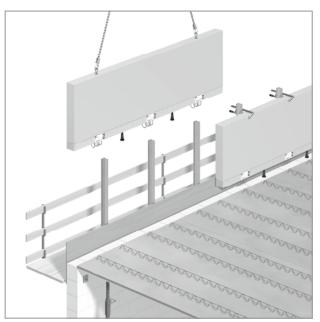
Schöck Isokorb® XT tipo A con soporte de montaje Combar® FT: Suspensión del peto prefabricado
